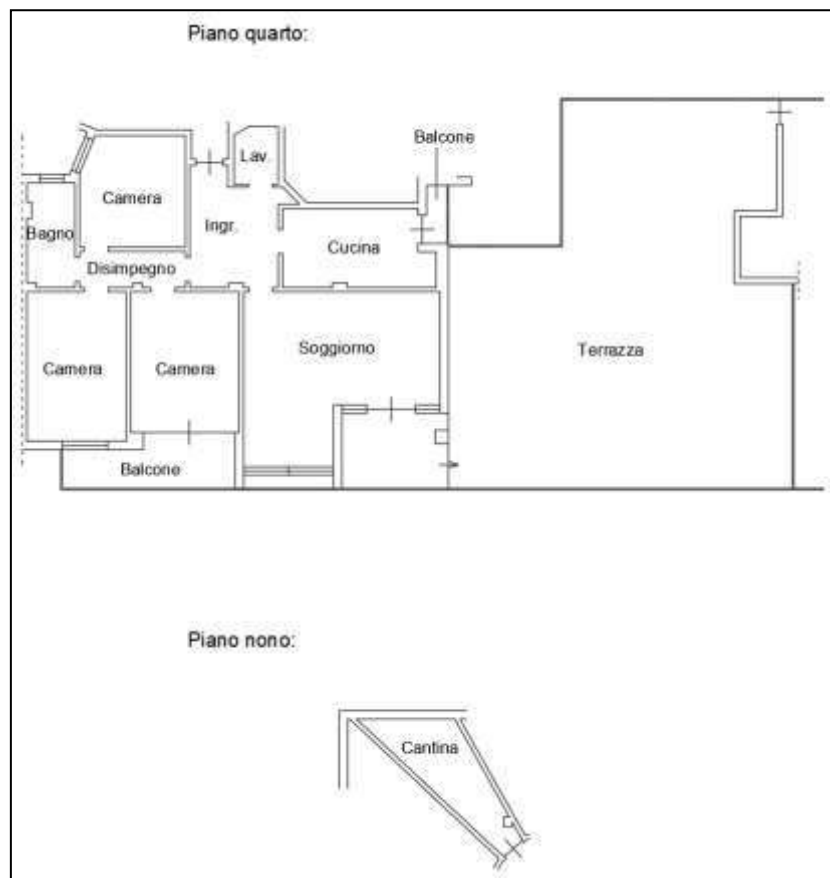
Schema planimetrico stato dei luoghi: fg. 12 m.n. 1335 sub 11
